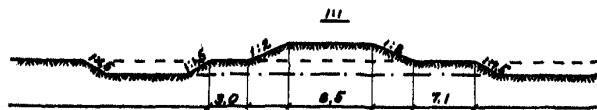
Схема разработки грунта в резервах бульдозерами (заросшие и ползаросшие барханные пески)
